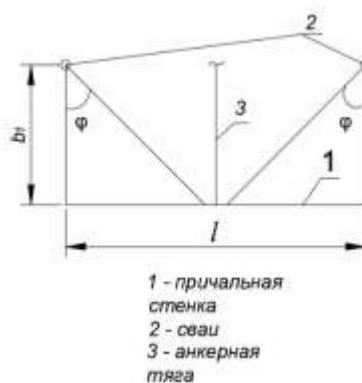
Схема изменения давления без перекрытия зон разгрузки от свай
